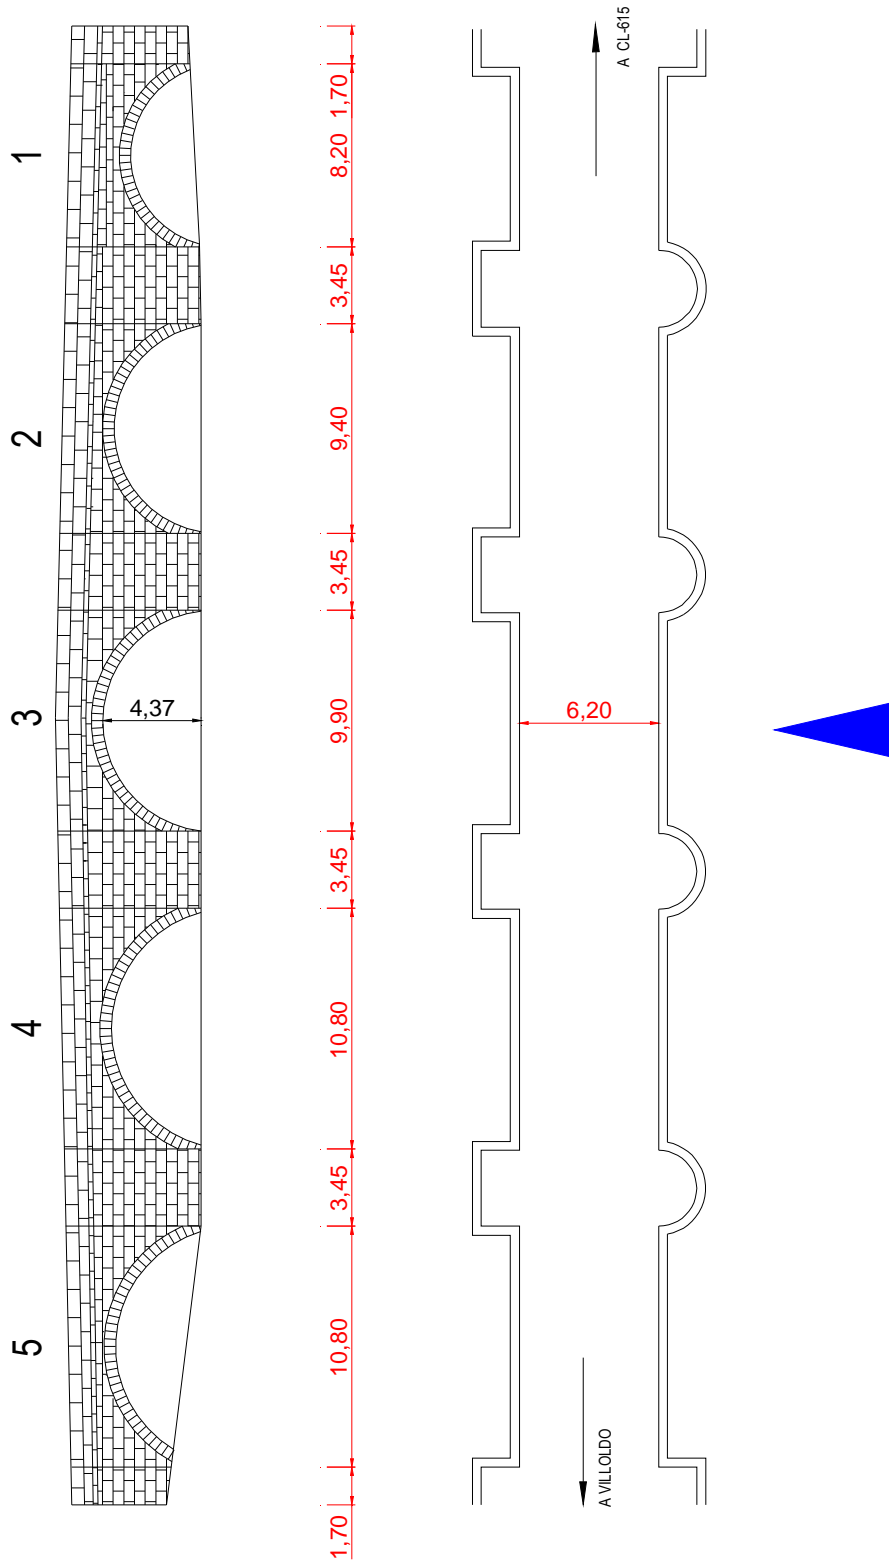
Planta y alzado de aguas arriba del puente en Villodo
